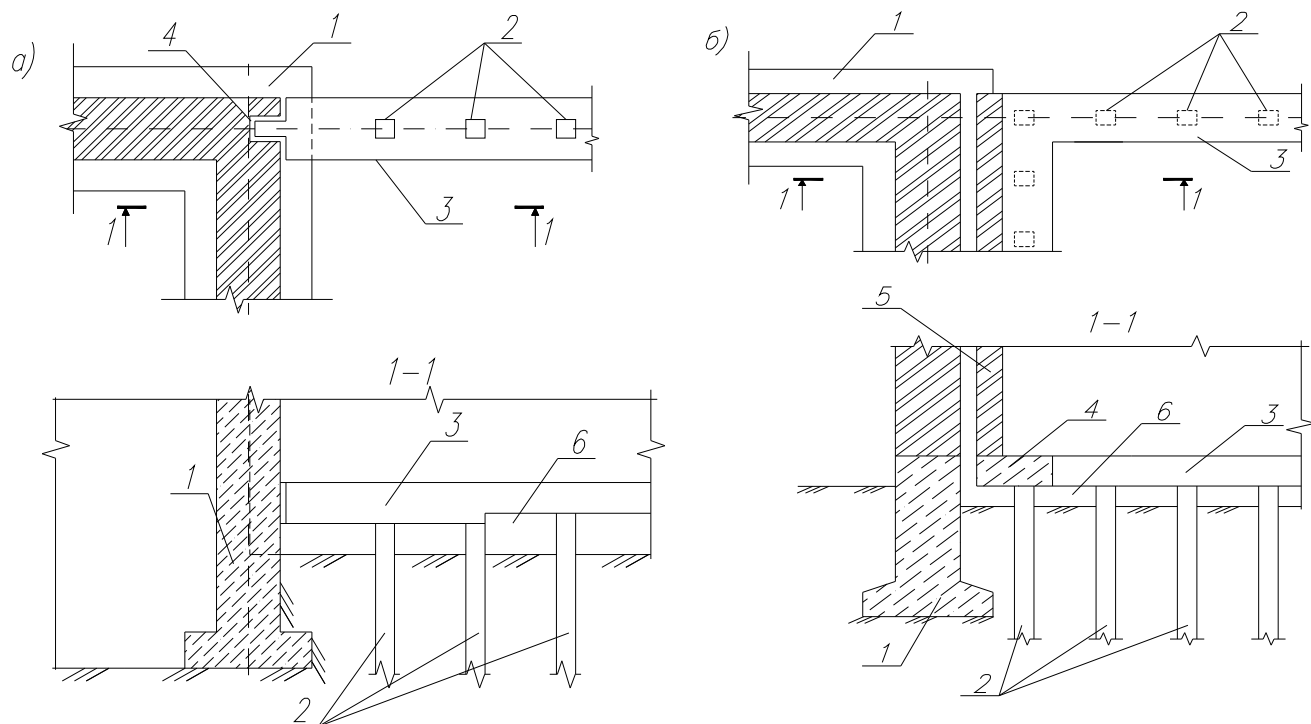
Примыкание свайных фундаментов к существующему зданию
